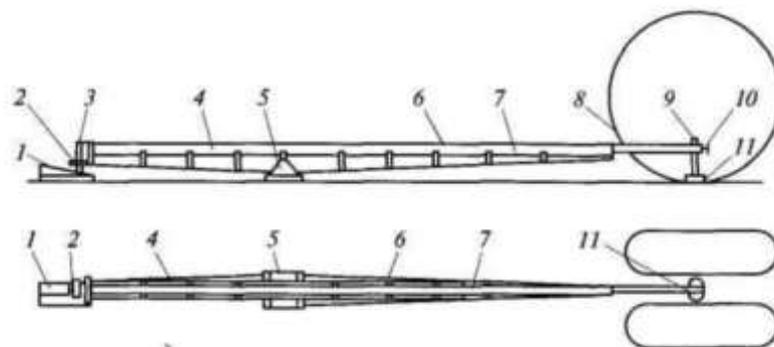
Длиннобазовый рычажный прогибомер:
